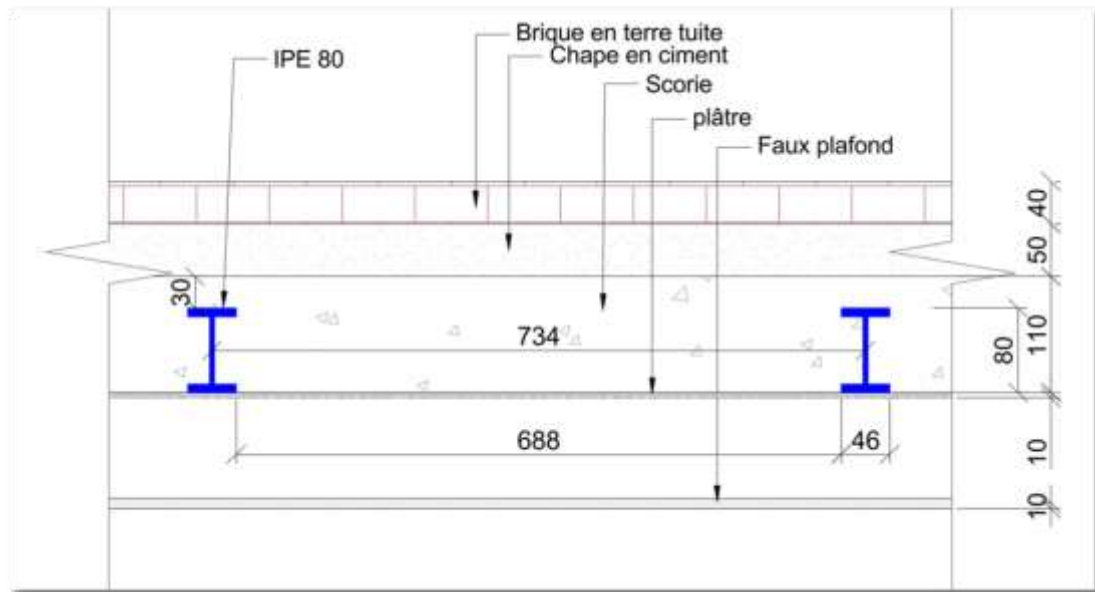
Coupe du plancher Sds-03 (portée 2,37 m)
